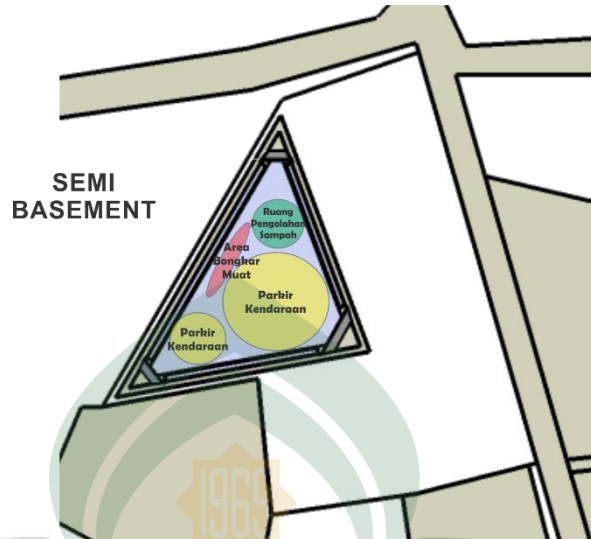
Zoning dalam Bangunan pada Bentuk Alternatif 2
